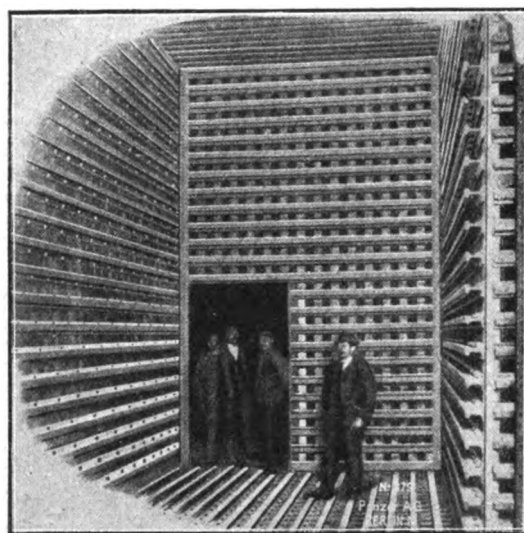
Camera del tesoro di una banca. Tutte le pareti, il soffitto e il pavimento sono corazzati con fitte rotelle di acciaio.
